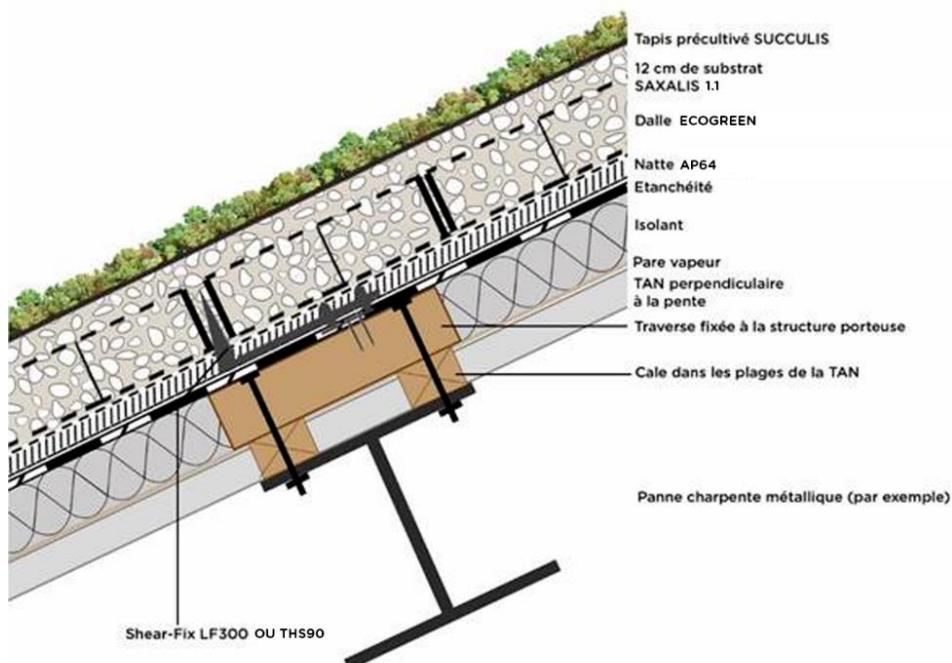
BIS : EXEMPLE DE FIXATION DES CROCHETS INTERMEDIAIRES TSH 90 OU SHEAR FIX LF300 SUR TRAVERSE FIXEE A LA STRUCTURE PORTEUSE AU TRAVERS DE TOILES D'ACIER NERVUREES
